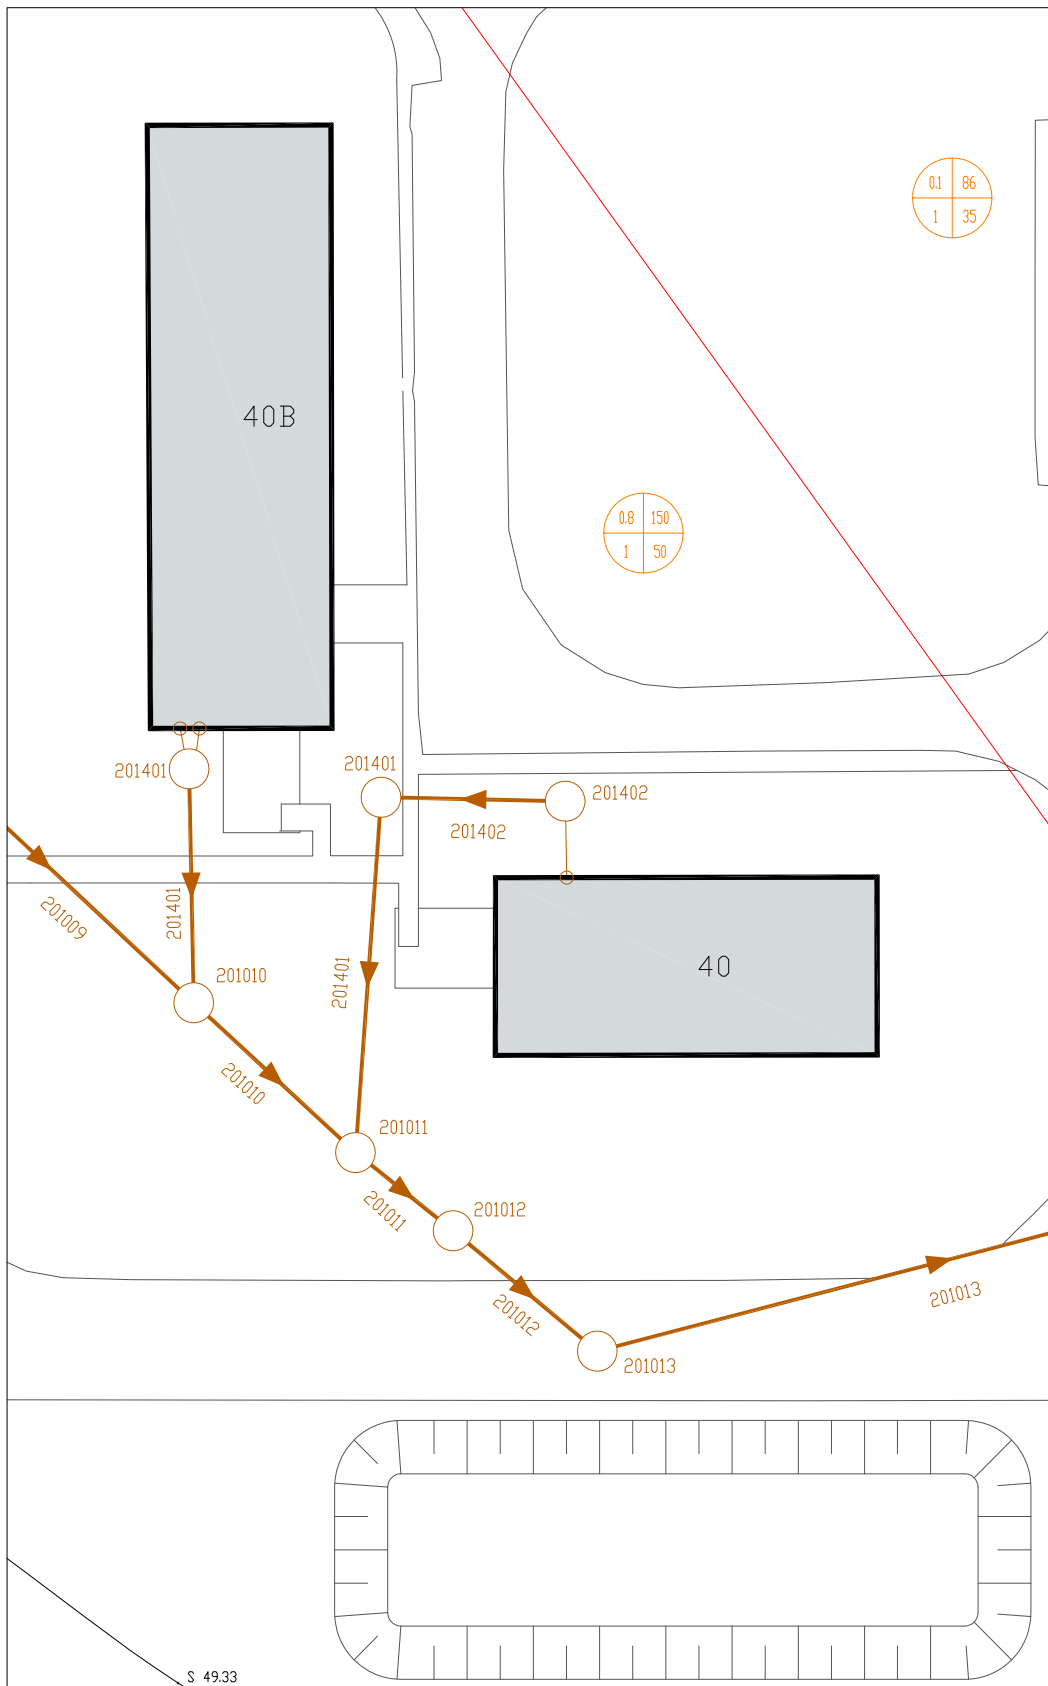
8 Beispielplan: Lageplan „Einzugsgebiet Trockenwetterabfluss“
